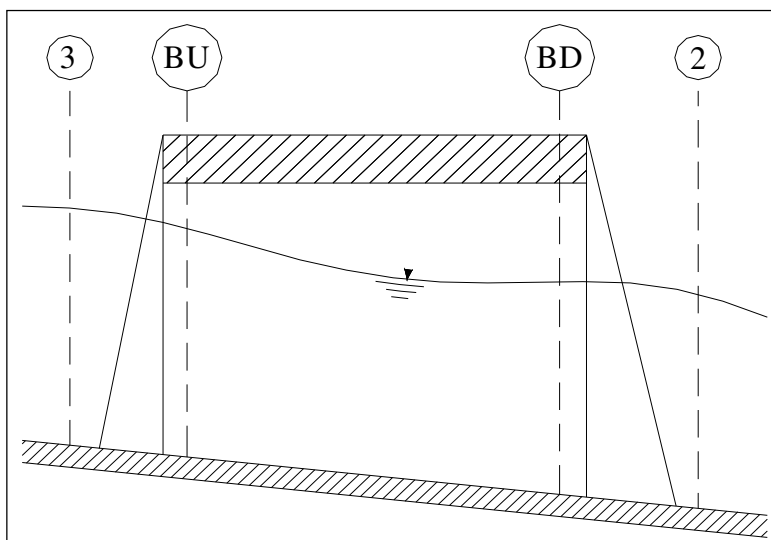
“Sezione schematica di un attraversamento fluviale”
